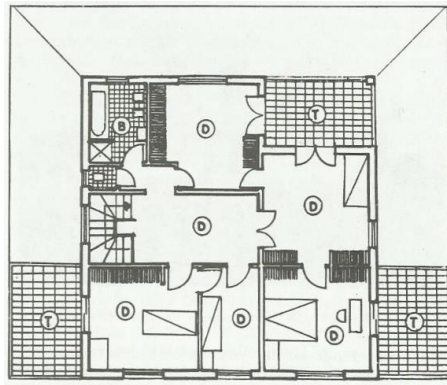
Planta do primeiro andar. Casa do arquiteto. Gregori Warchavchik, 1927-1928, São Paulo, SP
